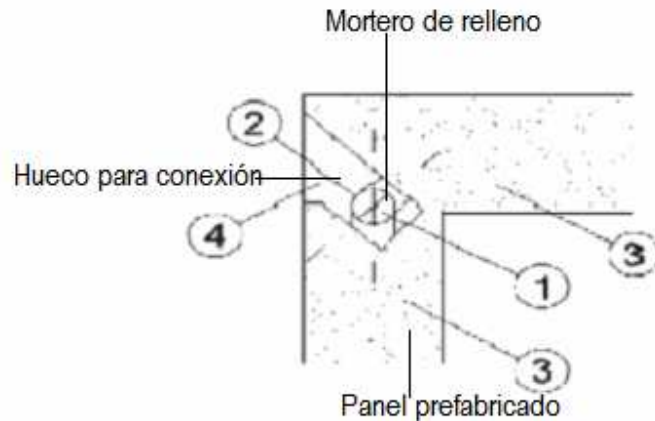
Esquina construcción mixta. Detalle de conexión húmeda de esquina. 1- Mortero de relleno, 2-Armaduras salientes de los paneles, 3-Panel prefabricado de hormigón, 4- Hueco para la conexión.
